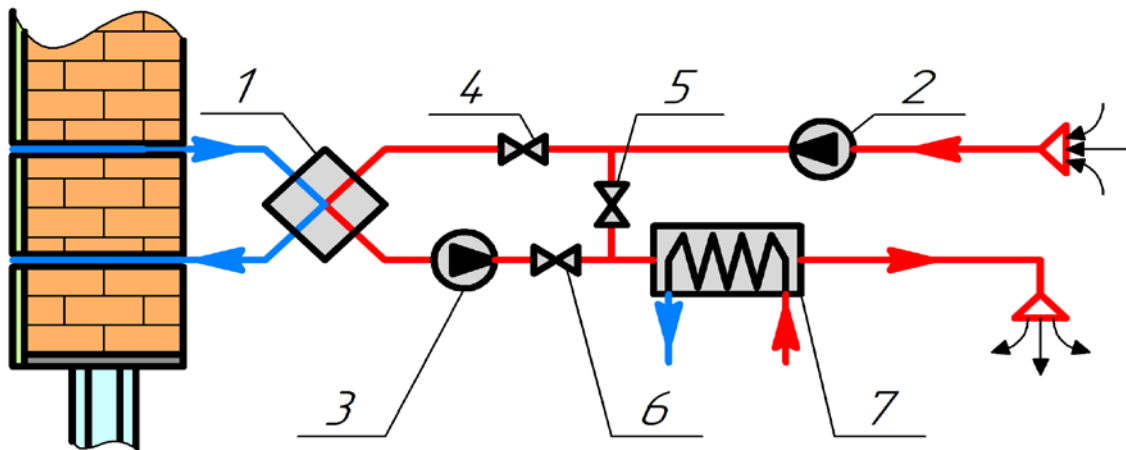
Схема приточно-вытяжной системы вентиляции с переключающим воздухопроводом:
